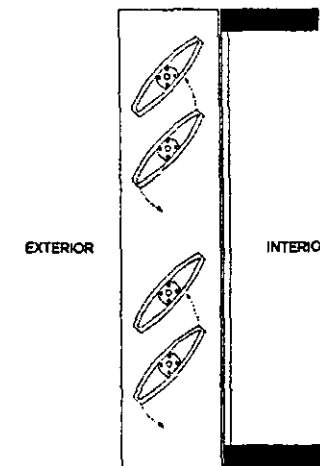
Posible sistema de protección contra huracanes. En corte láminas horizontales móviles.
